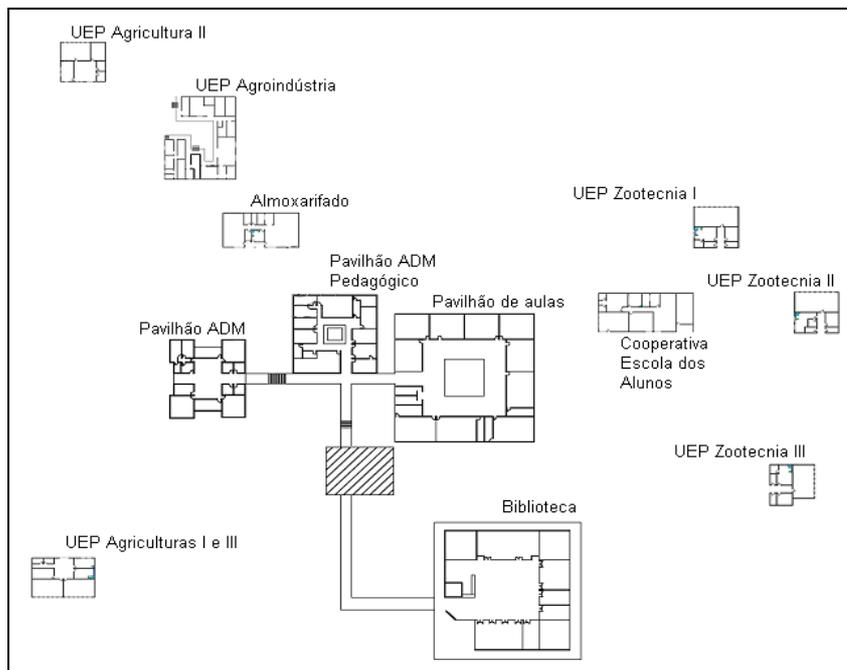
Planta Esquemática da EAF de Senhor do Bonfim
